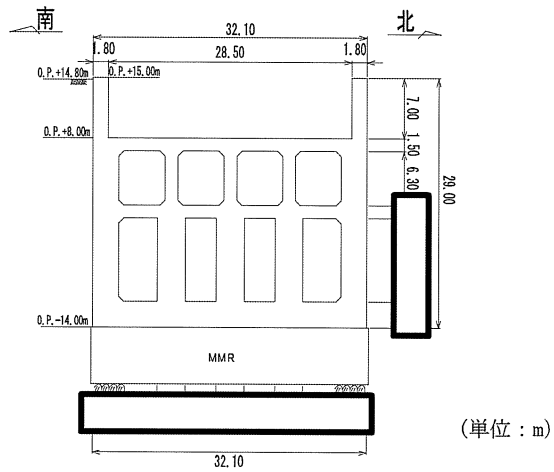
第 3 号機海水ポンプ室断面図 (A-A 断面)
